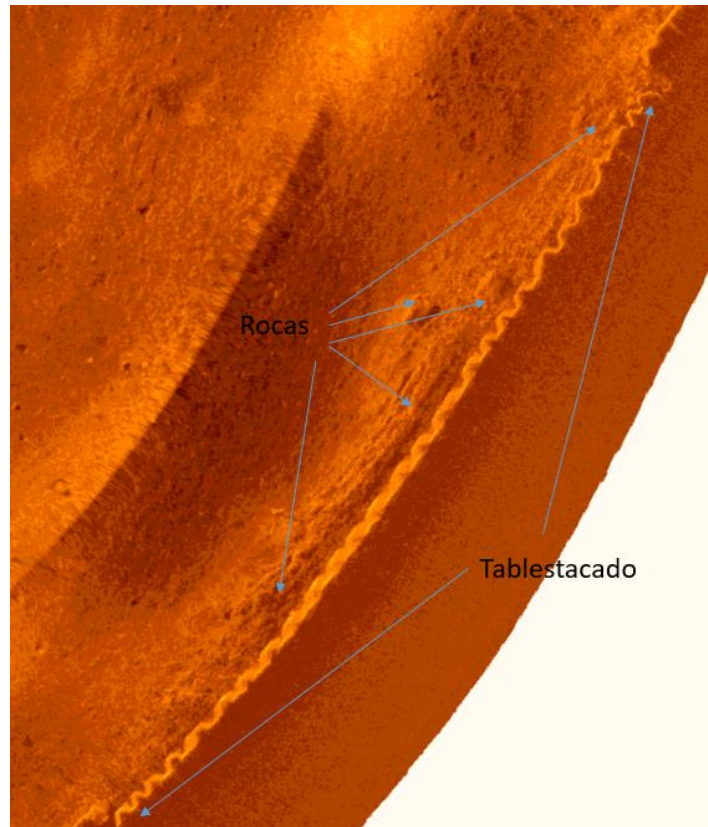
Sector 2 del muro perimetral con tablestacado imagen subacuática con SSS.
